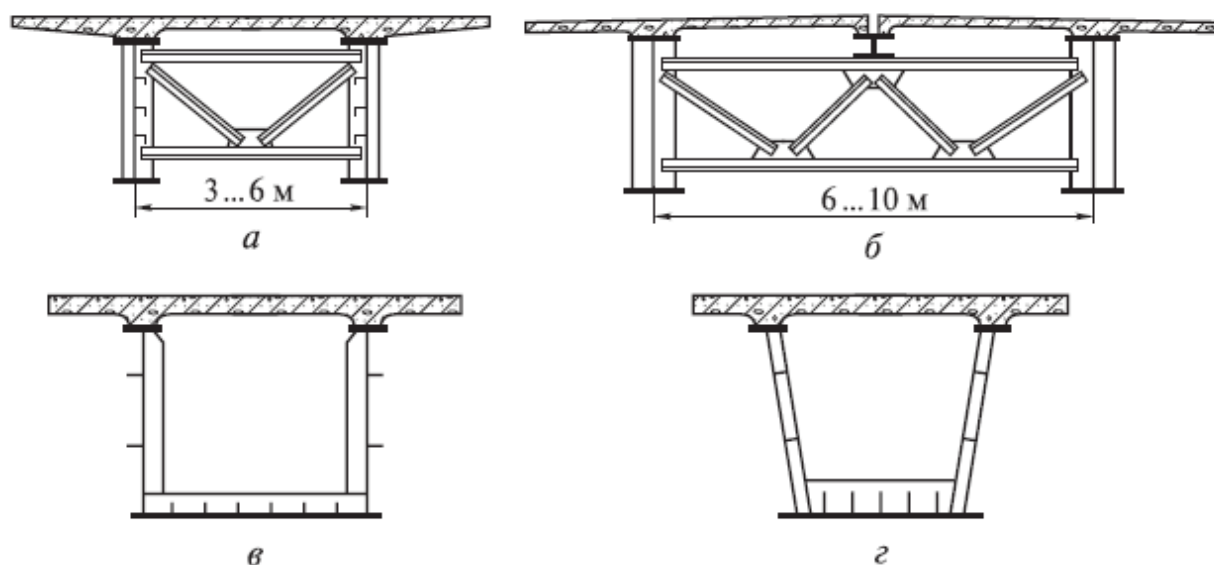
Типы поперечных сечений сталежелезобетонных пролетных строений:
